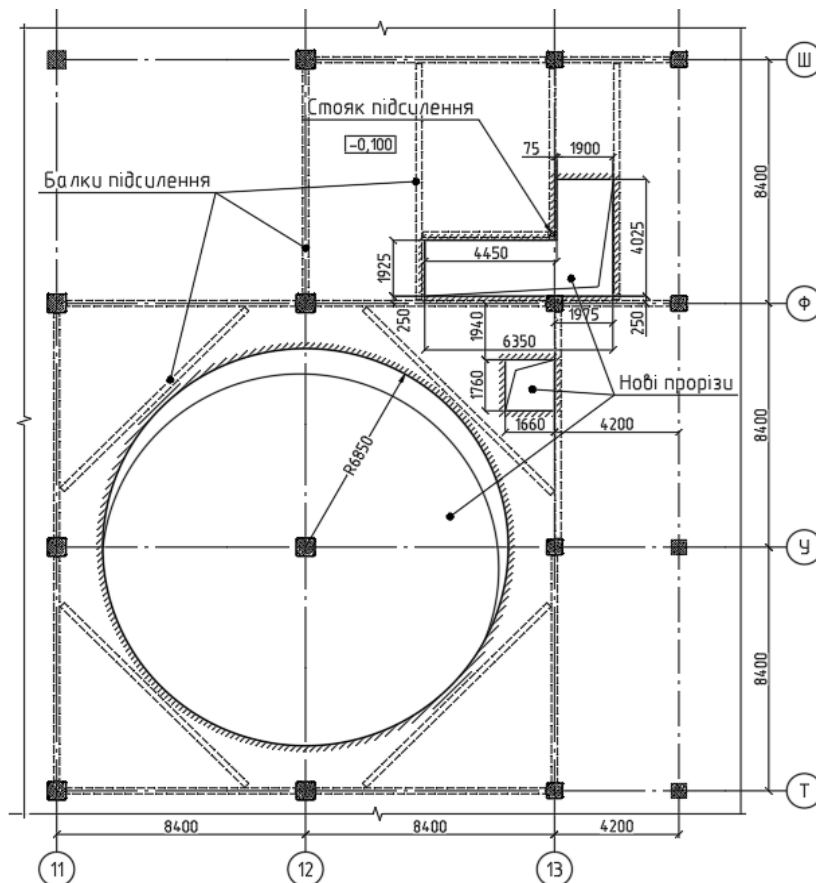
Фрагмент конструктивного плану з новими прорізами у перекритті і балками підсилення
